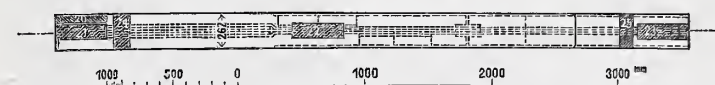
Obere Gurtung mit Bezeichnung der Gurtplatten-Proben. Versuchs-Trägerstück.
